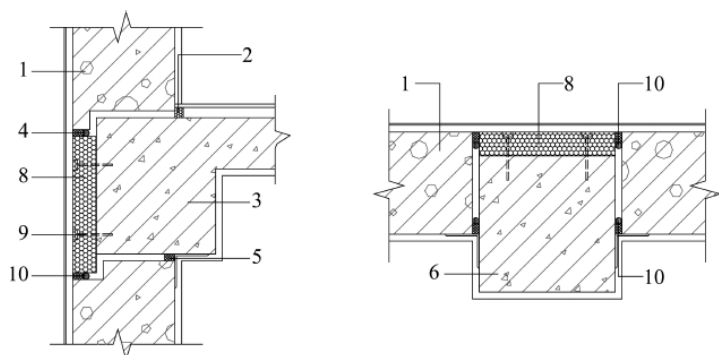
预制混凝土夹芯外挂墙板板缝构造示意图
